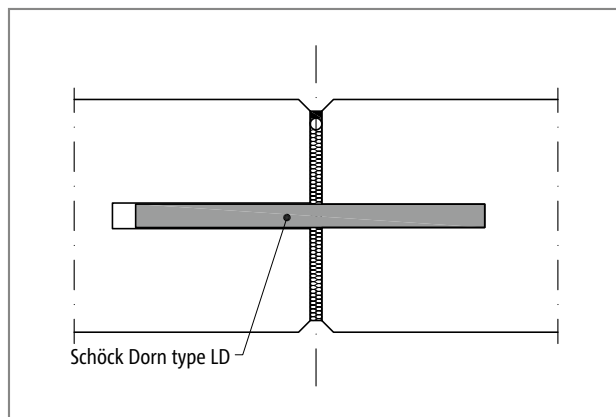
Schöck Dorn : Formation de joints de dilatation - béton coulé sur site
